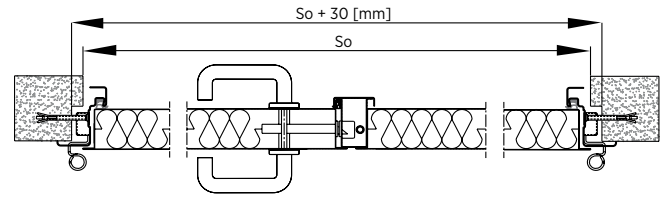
Montage zweiflügeliger Türen mit Eckzarge an der Mauer - Horizontalschnitt
